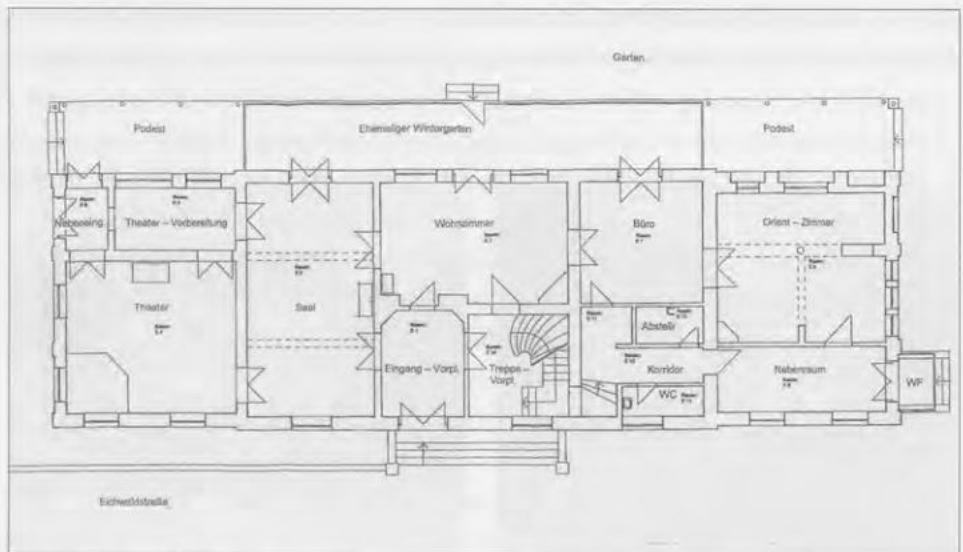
Villa Leuchtenberg, Grundriss des Erdgeschosses (gegenüber dem Originalzustand leicht verändert)
